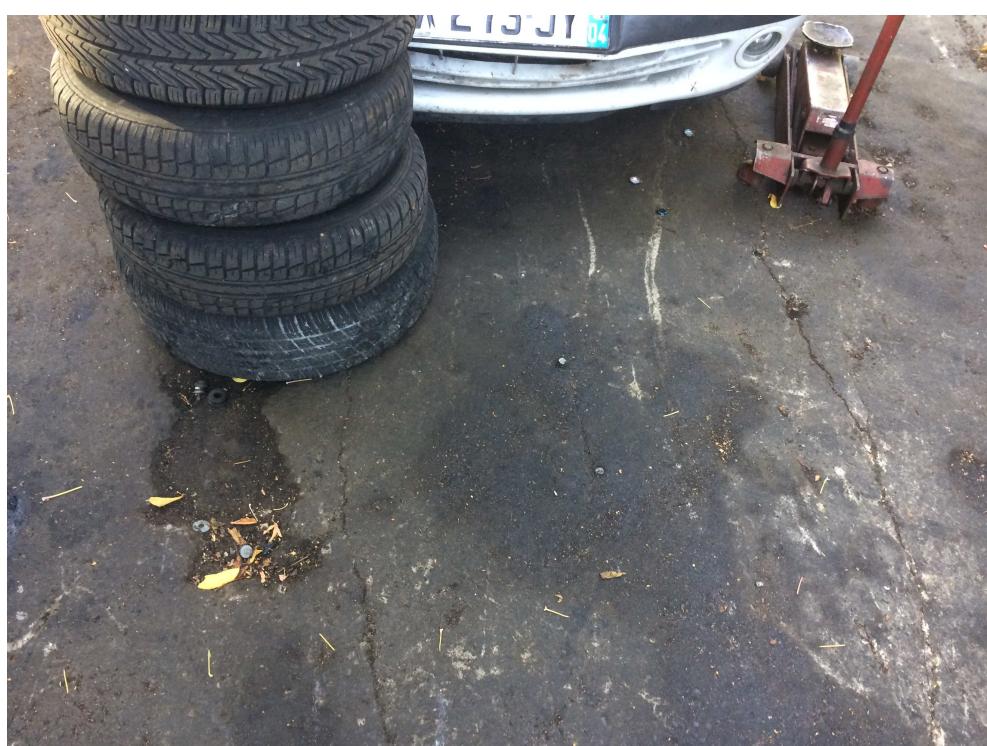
Défaut d'étanchéité dans la dalle béton du site
